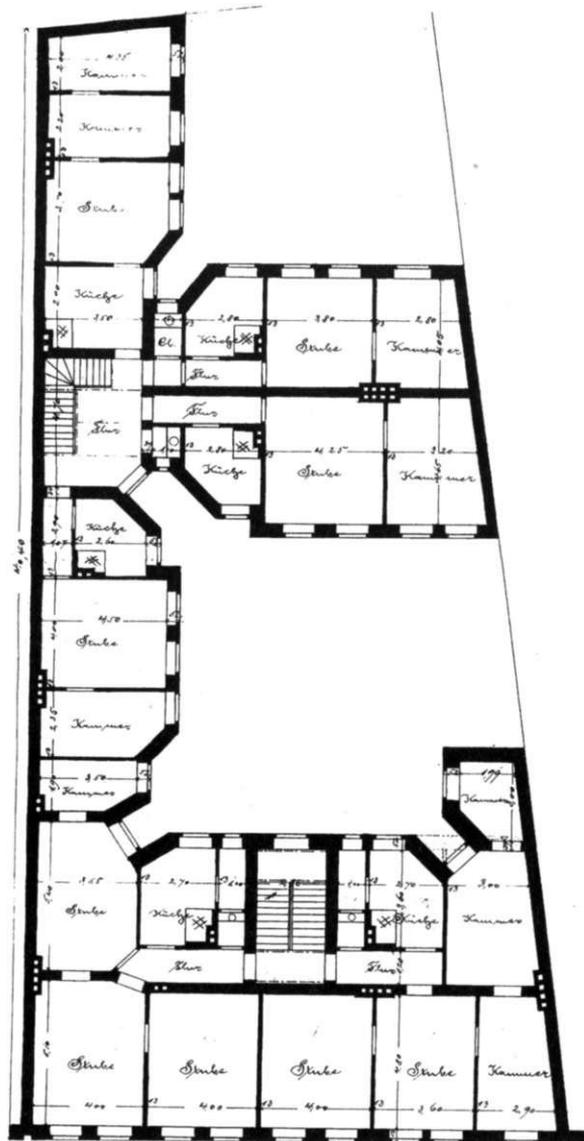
Grundrißtyp G, Hans-Löcher-Straße 20
